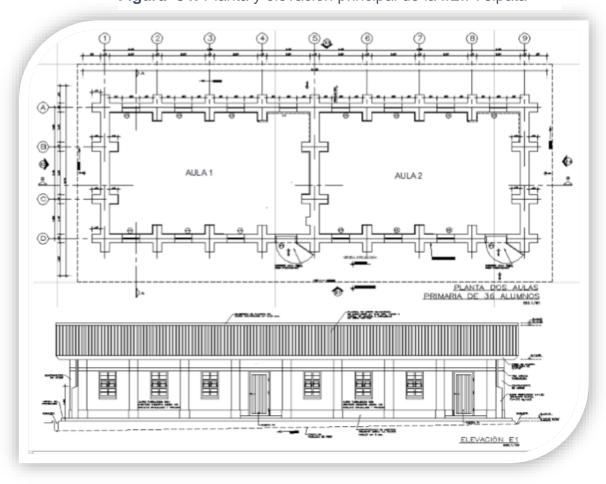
Planta y elevación principal de la I.E.P. Jipata
